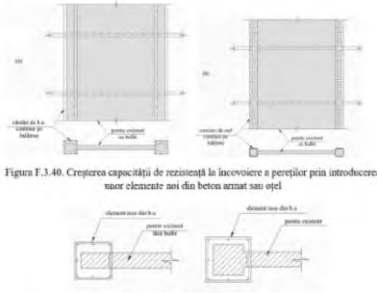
Creșterea capacității de rezistență la încovoiere a pereților prin introducerea unor elemente noi din beton armat sau oțel
